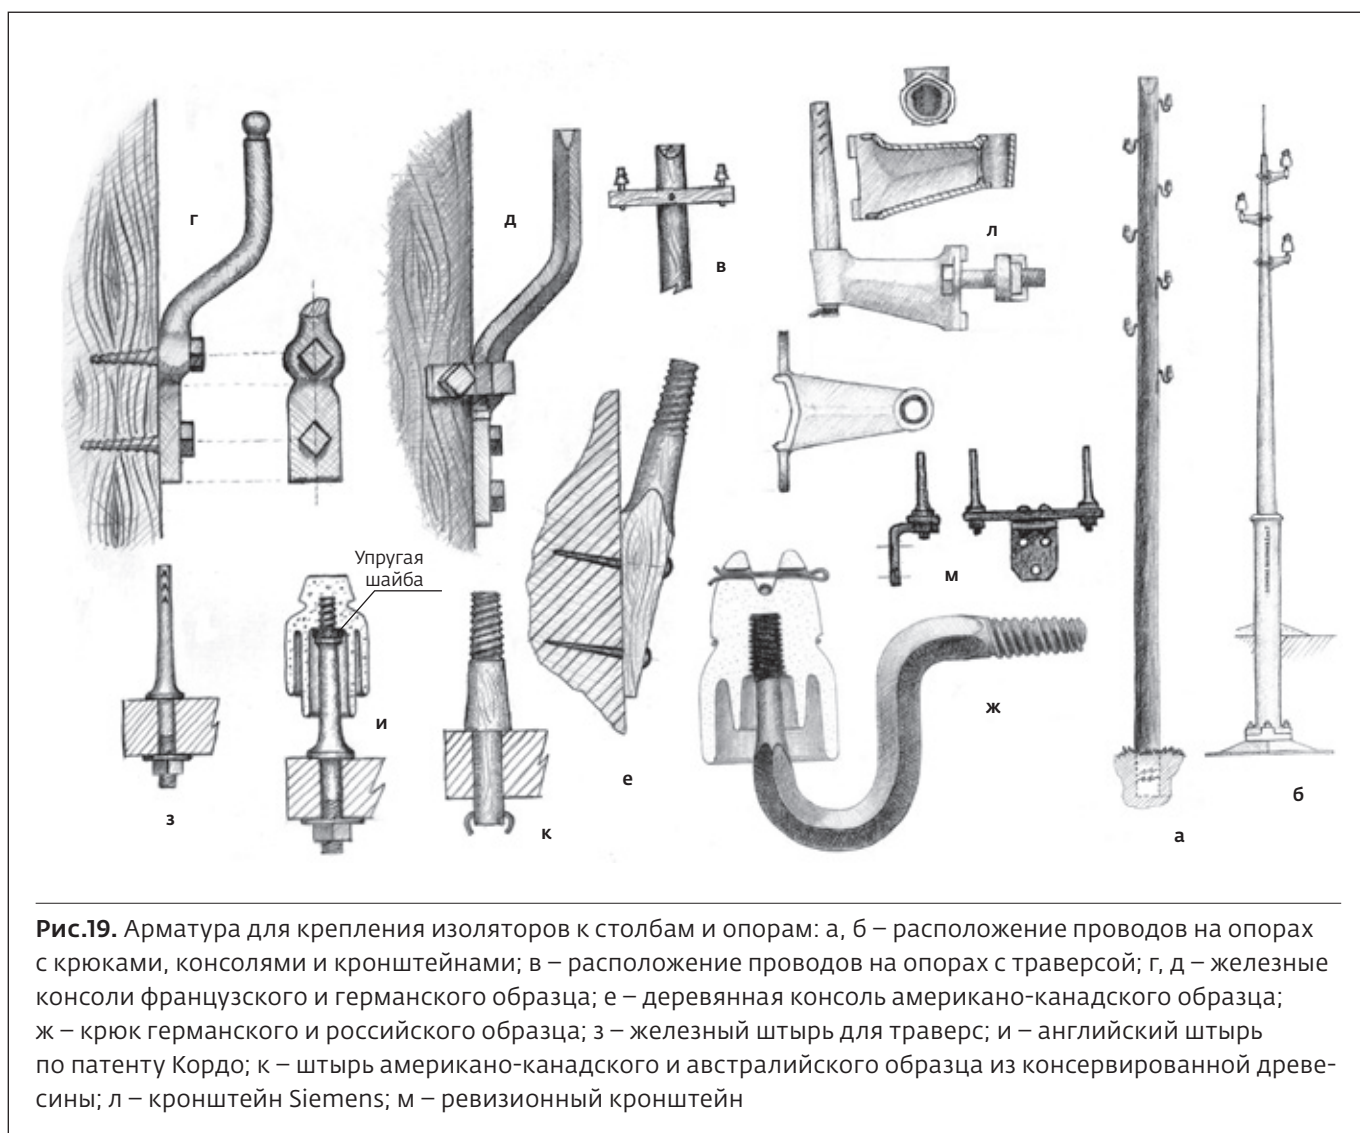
Арматура для крепления изоляторов к столбам и опорам: а, б – расположение проводов на опорах с крюками, консолями и кронштейнами; в – расположение проводов на опорах с траверсой; г, д – железные консоли французского и германского образца; е – деревянная консоль американско-канадского образца; ж – крюк германского и российского образца; з – железный штырь для траверс; и – английский штырь по патенту Кордо; к – штырь американско-канадского и австралийского образца из консервированной древесины; л – кронштейн Siemens; м – ревизионный кронштейн
